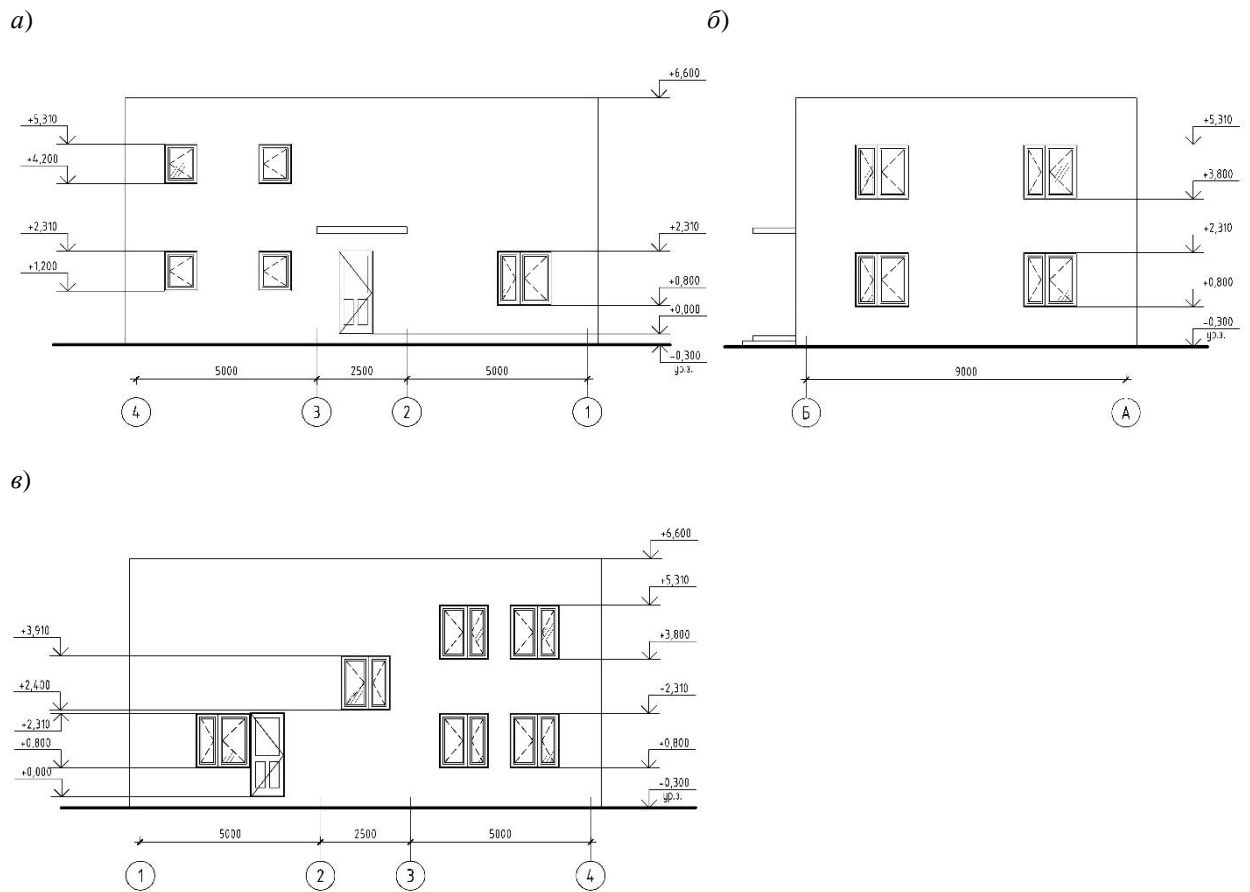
Схема расположения окон и входных дверей в составе стеновых конструкций: а) – стена по оси Б; б) – стена по оси 1; в) – стена по оси А
